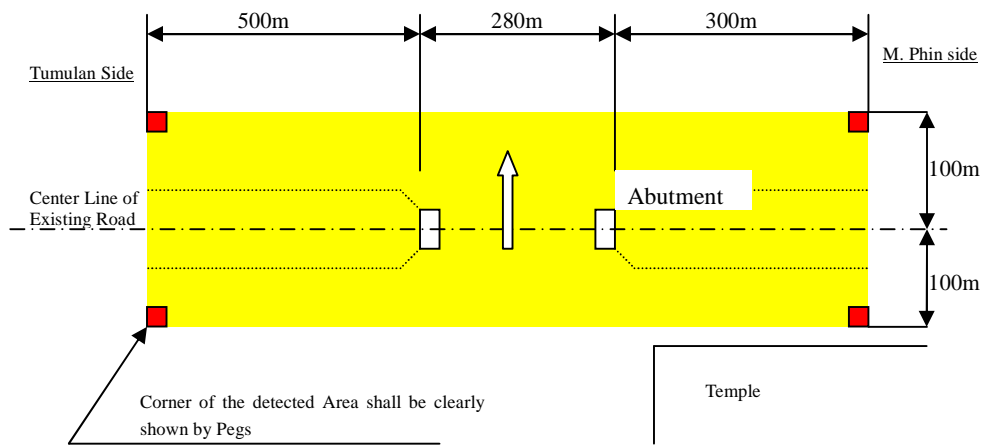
UXO 調査範囲 (Tat hai Bridge)
